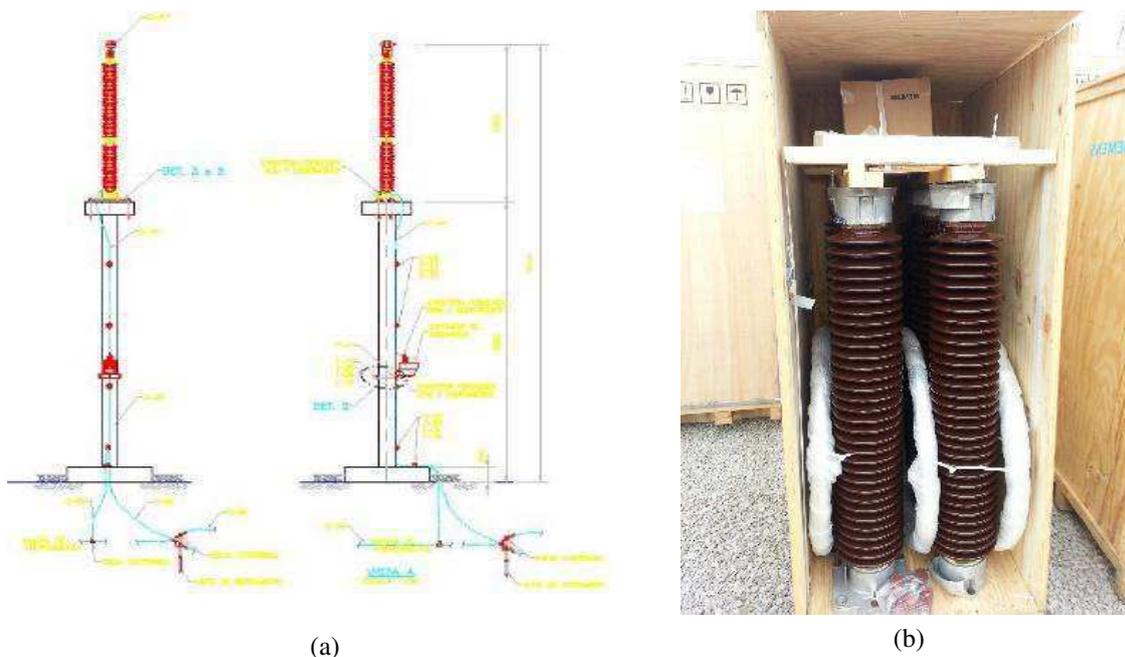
Para-raios: (a) Detalhes de Montagem; (b) Para-raios a ser instalado.
